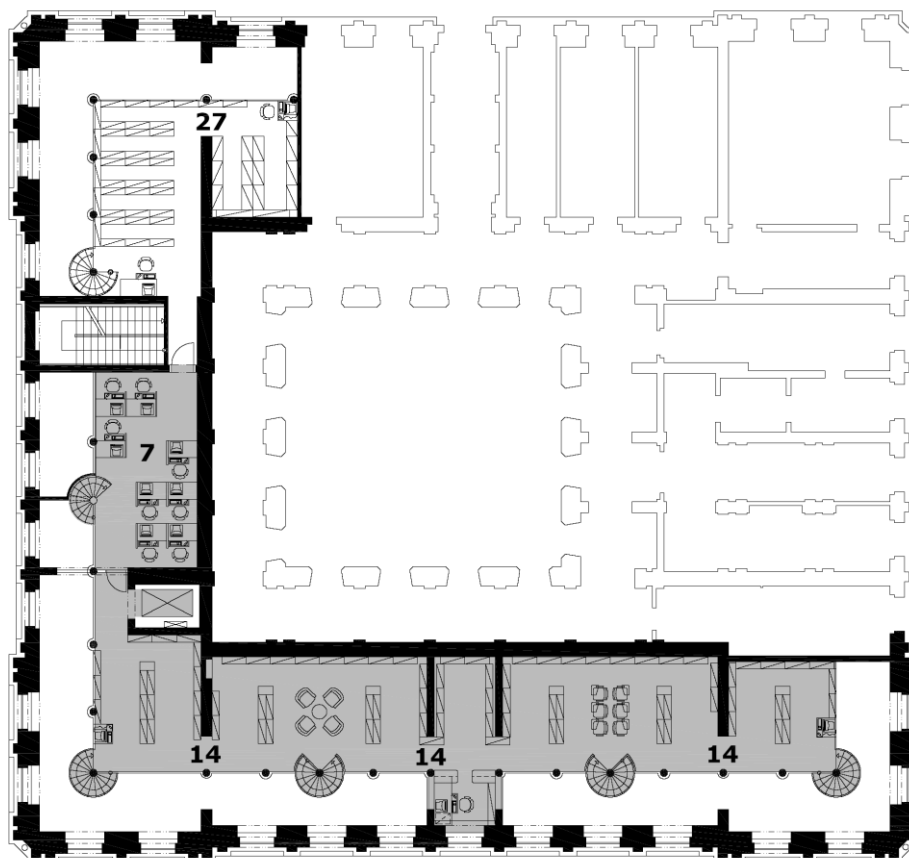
Městská knihovna v Plané, 2010, půdorys 1. patra (projekt Ing. arch. Kateřina Hořavová).
